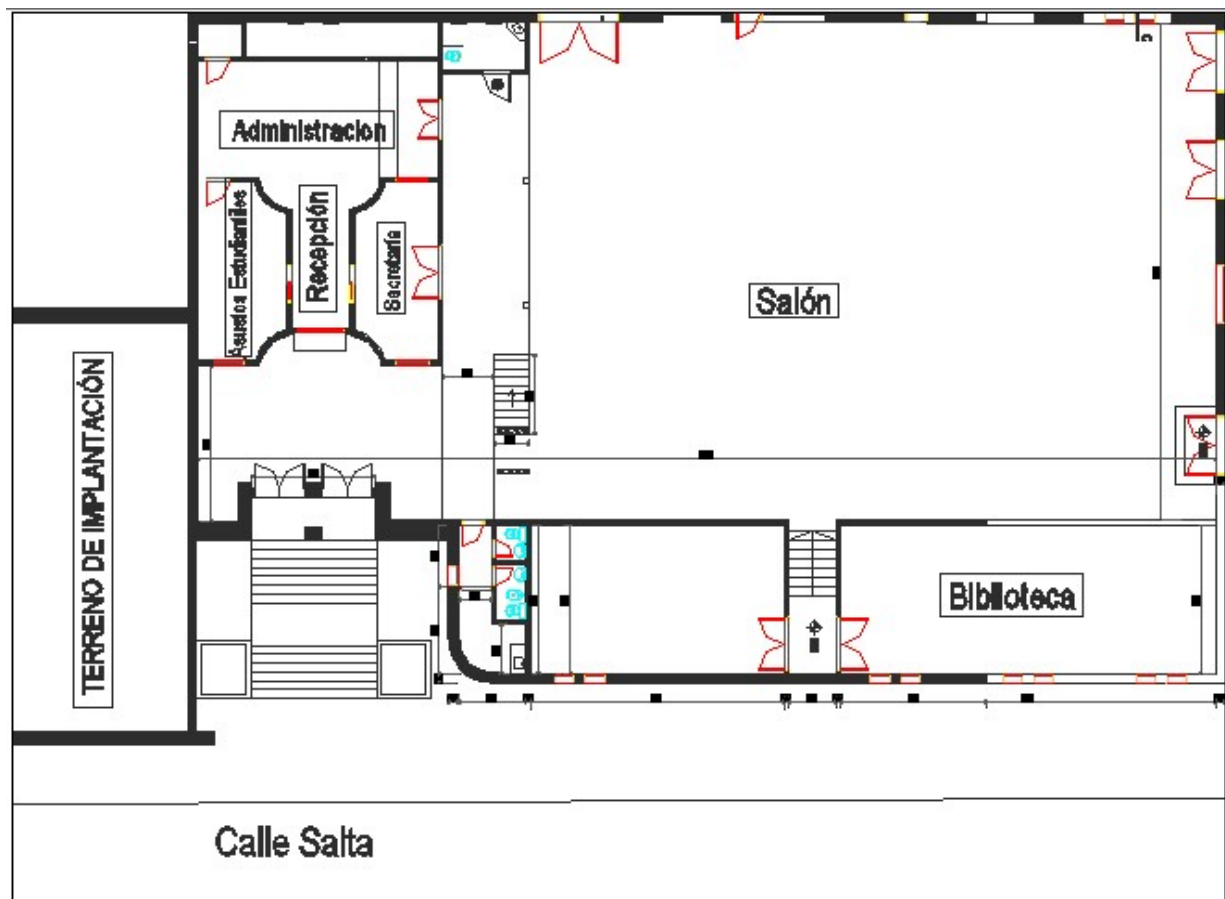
Plano de planta baja del sector de la facultad involucrado.
